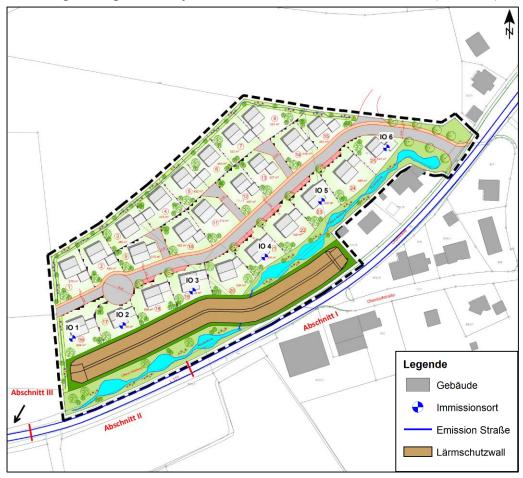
Lage der Straßenabschnitte und der Immissionsorte (ohne Wall)
